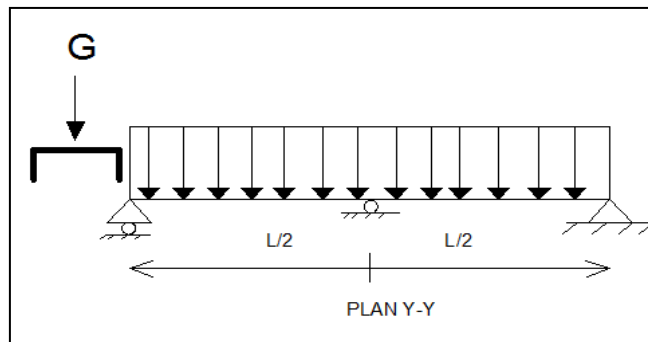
Schéma statique de la lisse selon le plan y-y.
